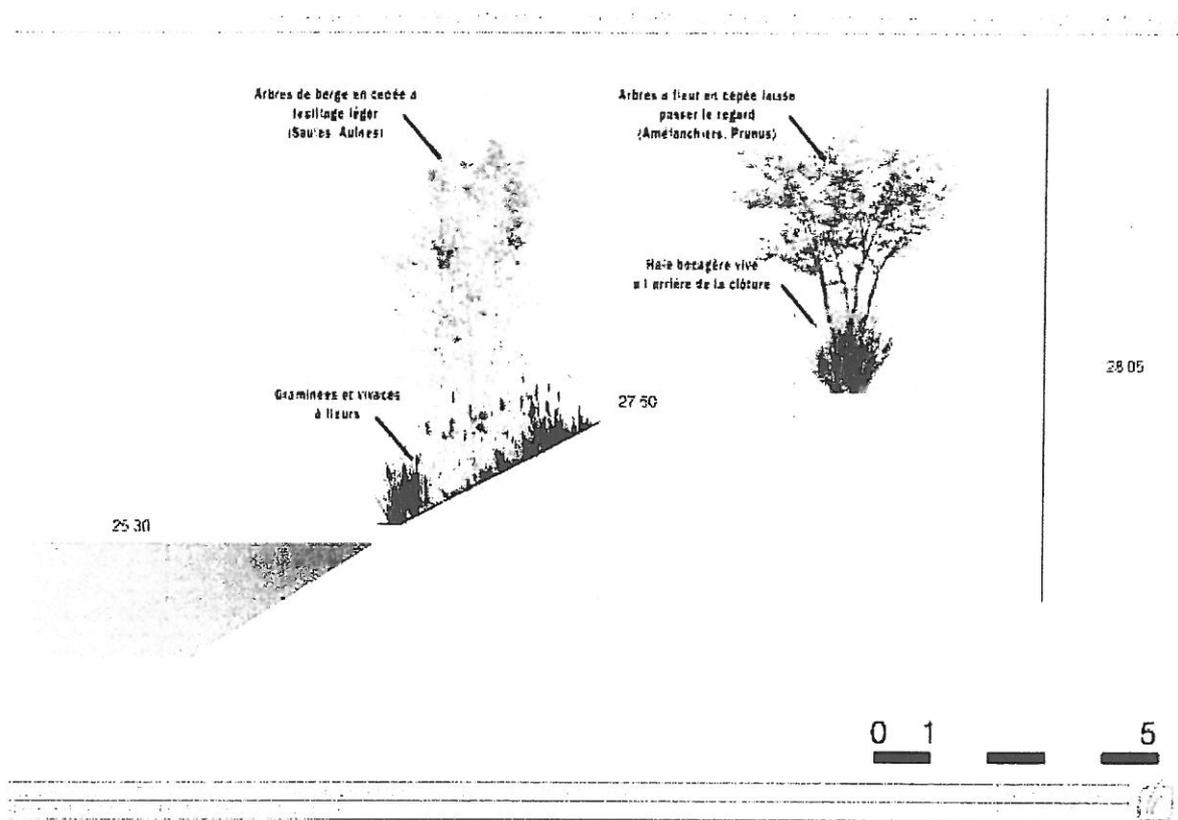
Coupes de principe sur les plantations le long du mail piéton (TRAIT VERT, Mai 2012)
